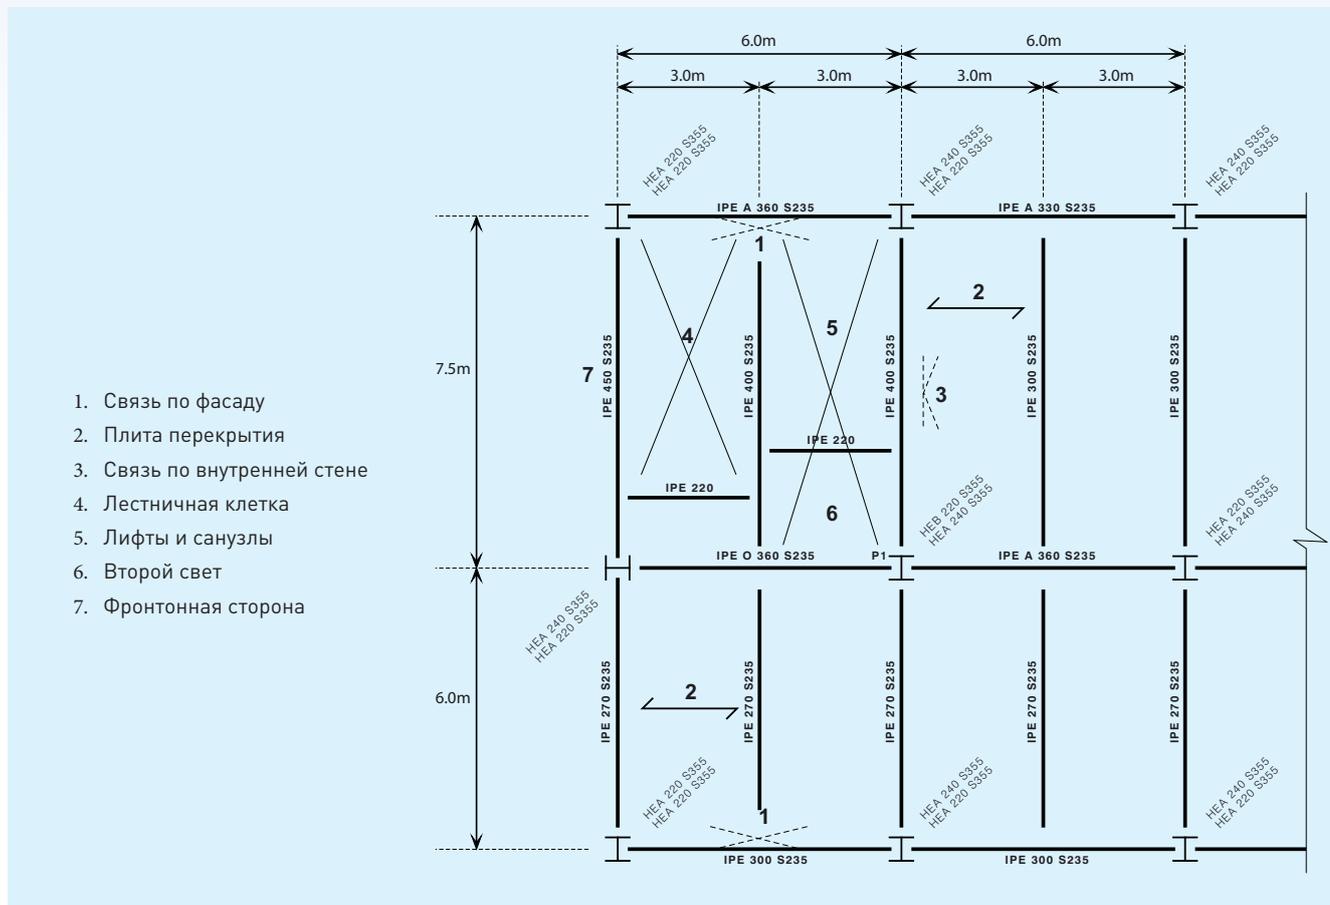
План расположения конструктивных элементов несущего каркаса четырехэтажного здания с композитными перекрытиями
